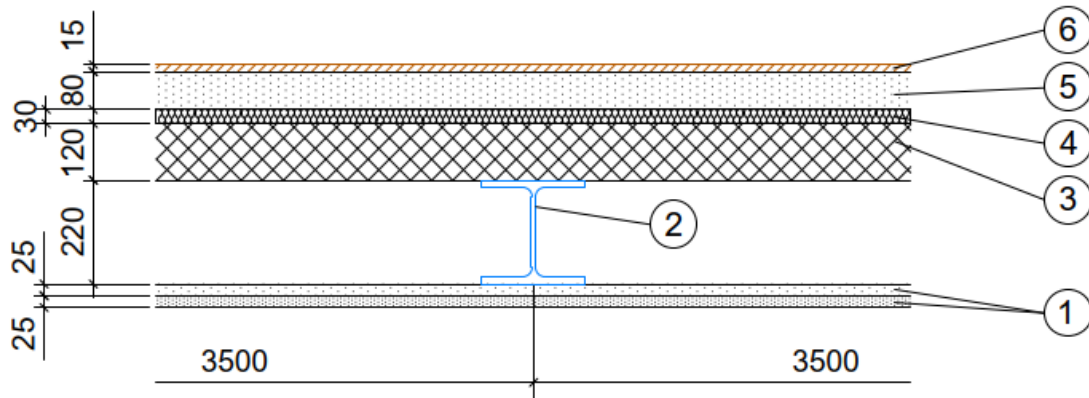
Aufbau Stahl-Beton-Verbunddecke
